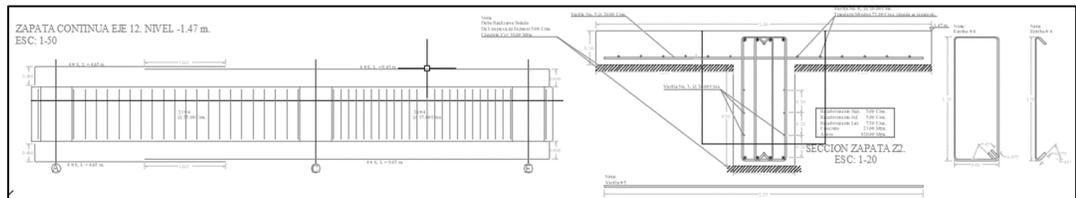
, despiece de acero de refuerzo, Viga eje 12 - 11 - 10, Fuente: Constructora Open House
